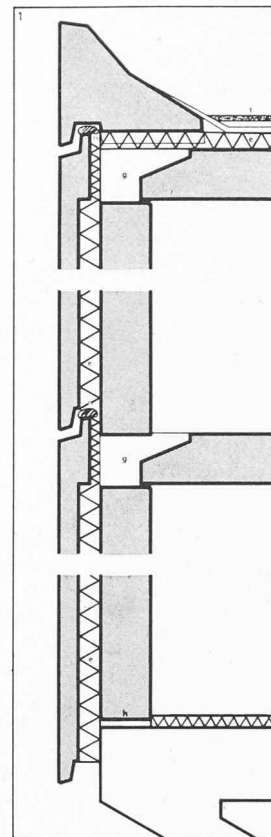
Coupe verticale sur façades porteuses. Joints horizontaux ouverts.
